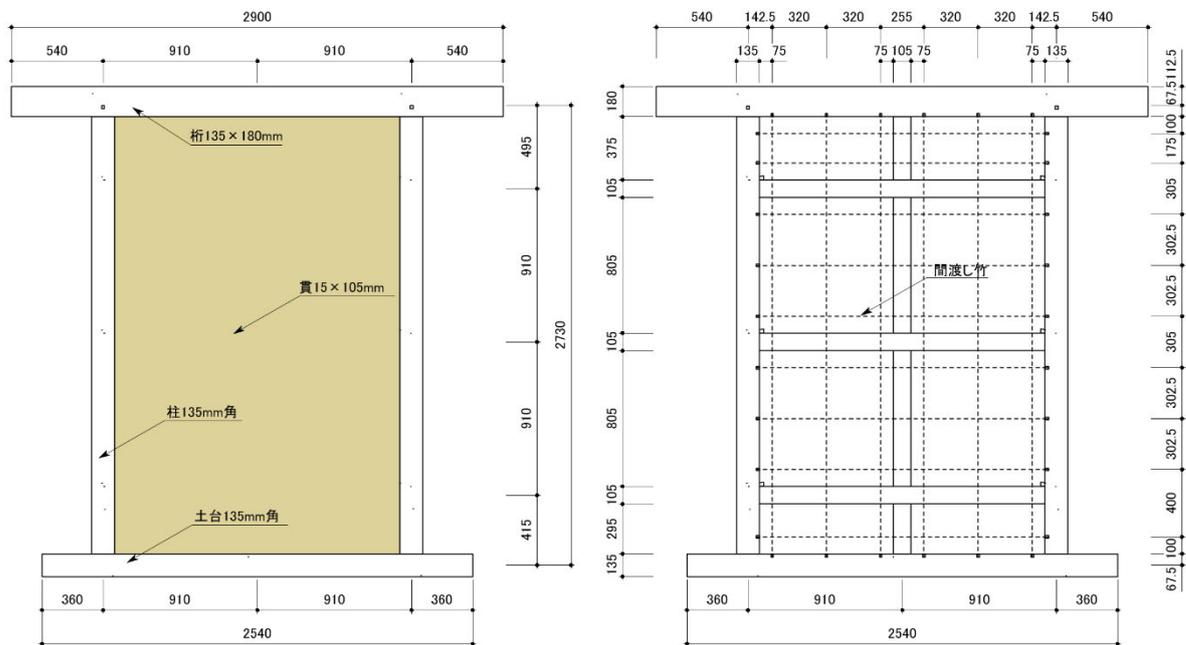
試験体 1（全面土壁）試験体詳細
